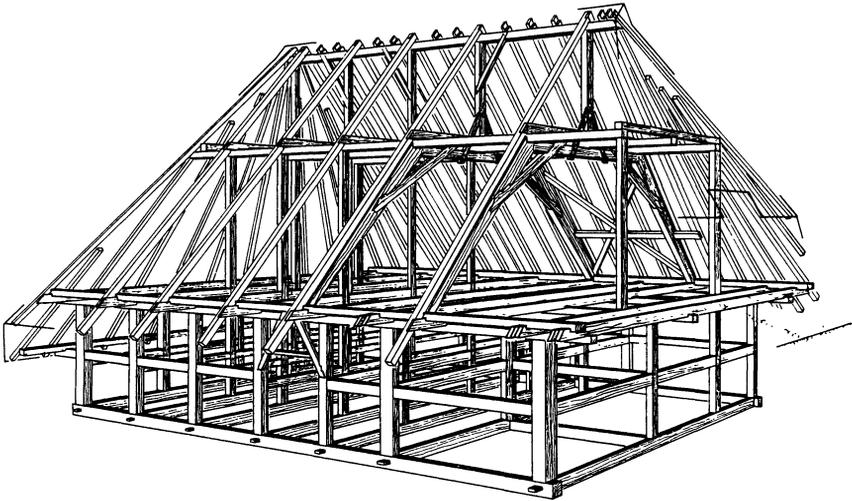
Tragwerk eines Höhenhauses mit Schwellenkranz, Firstständerkonstruktion im Stallteil und liegenden Stühlen mit abgefangenen Restfirstständern über dem Wohnteil.
